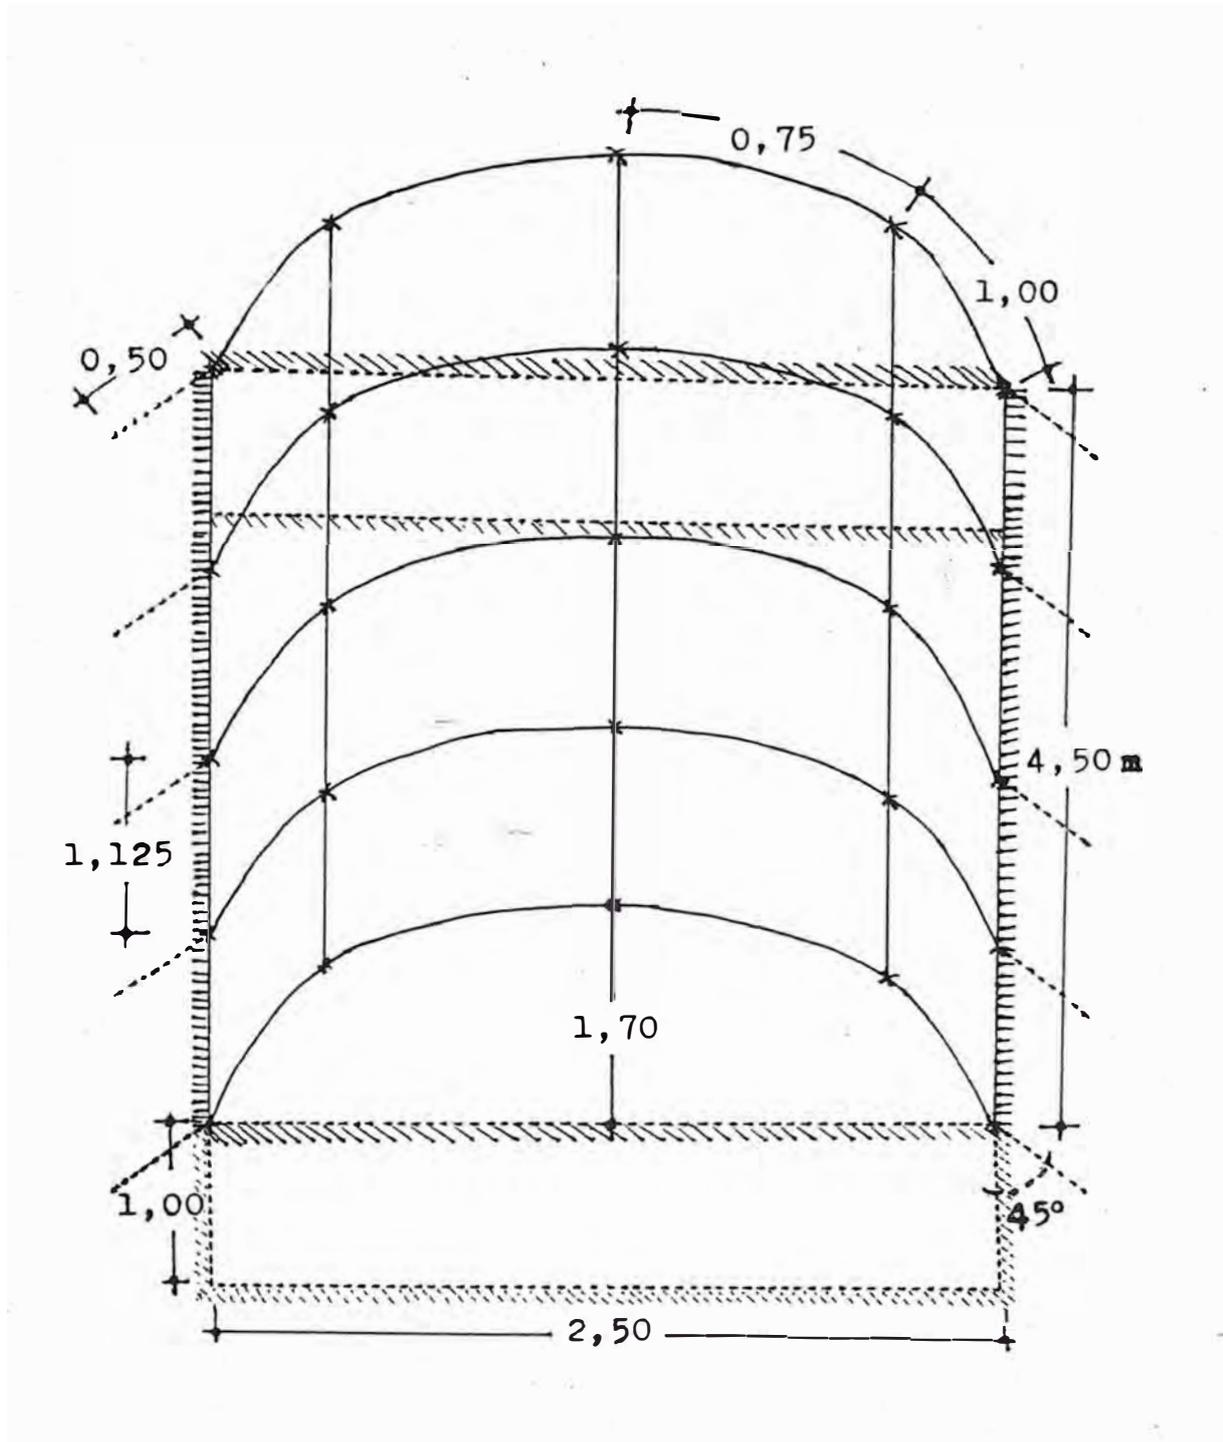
ESTABILIZACION DE LAS ESTRUCTURAS DEL INVERNADERO "ENTERRADO" CON ESTRUCTURAS DE TIPO "TUNEL".
